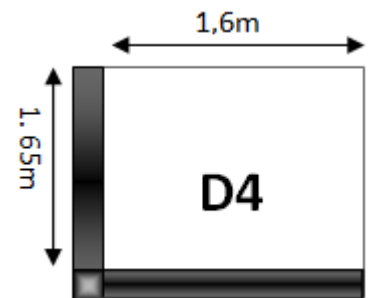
Schéma de la dalle pleine sur 2 appuis
